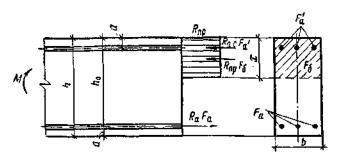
Схема усилий и эпюра напряжений в сечении, нормальном к продольной оси изгибаемого железобетонного элемента, при расчете его по прочности
